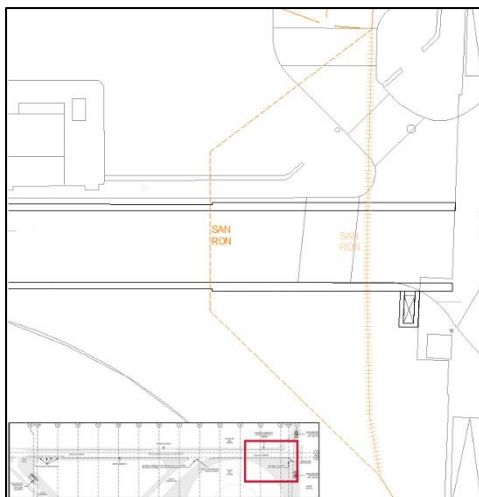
Plano de reposición SAN-RONDA-SR-CX-F7
